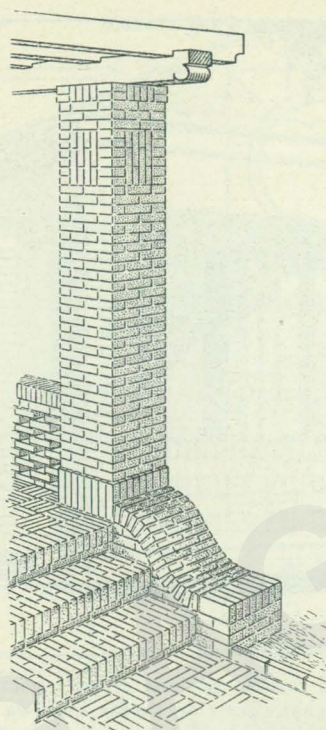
Rysunek wskazuje nam wejście frontowe pomiędzy pilastrami z cegły cementowej; na dole widzimy stopnie schodkowe, wykonane również z cegły cementowej.
